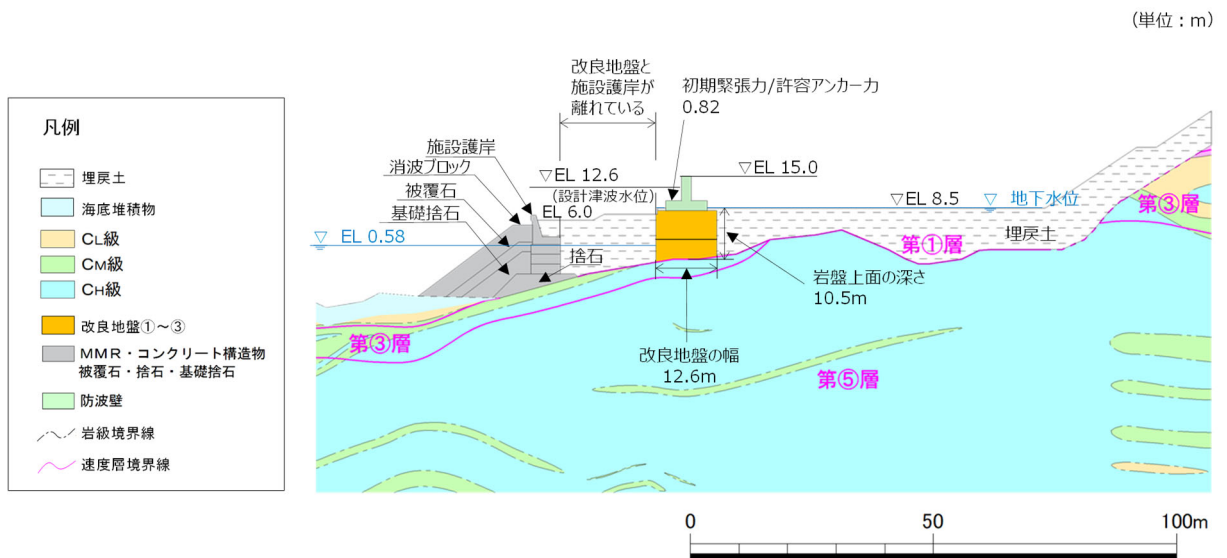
防波壁（逆 T 擁壁）の横断面図（②-②断面）
